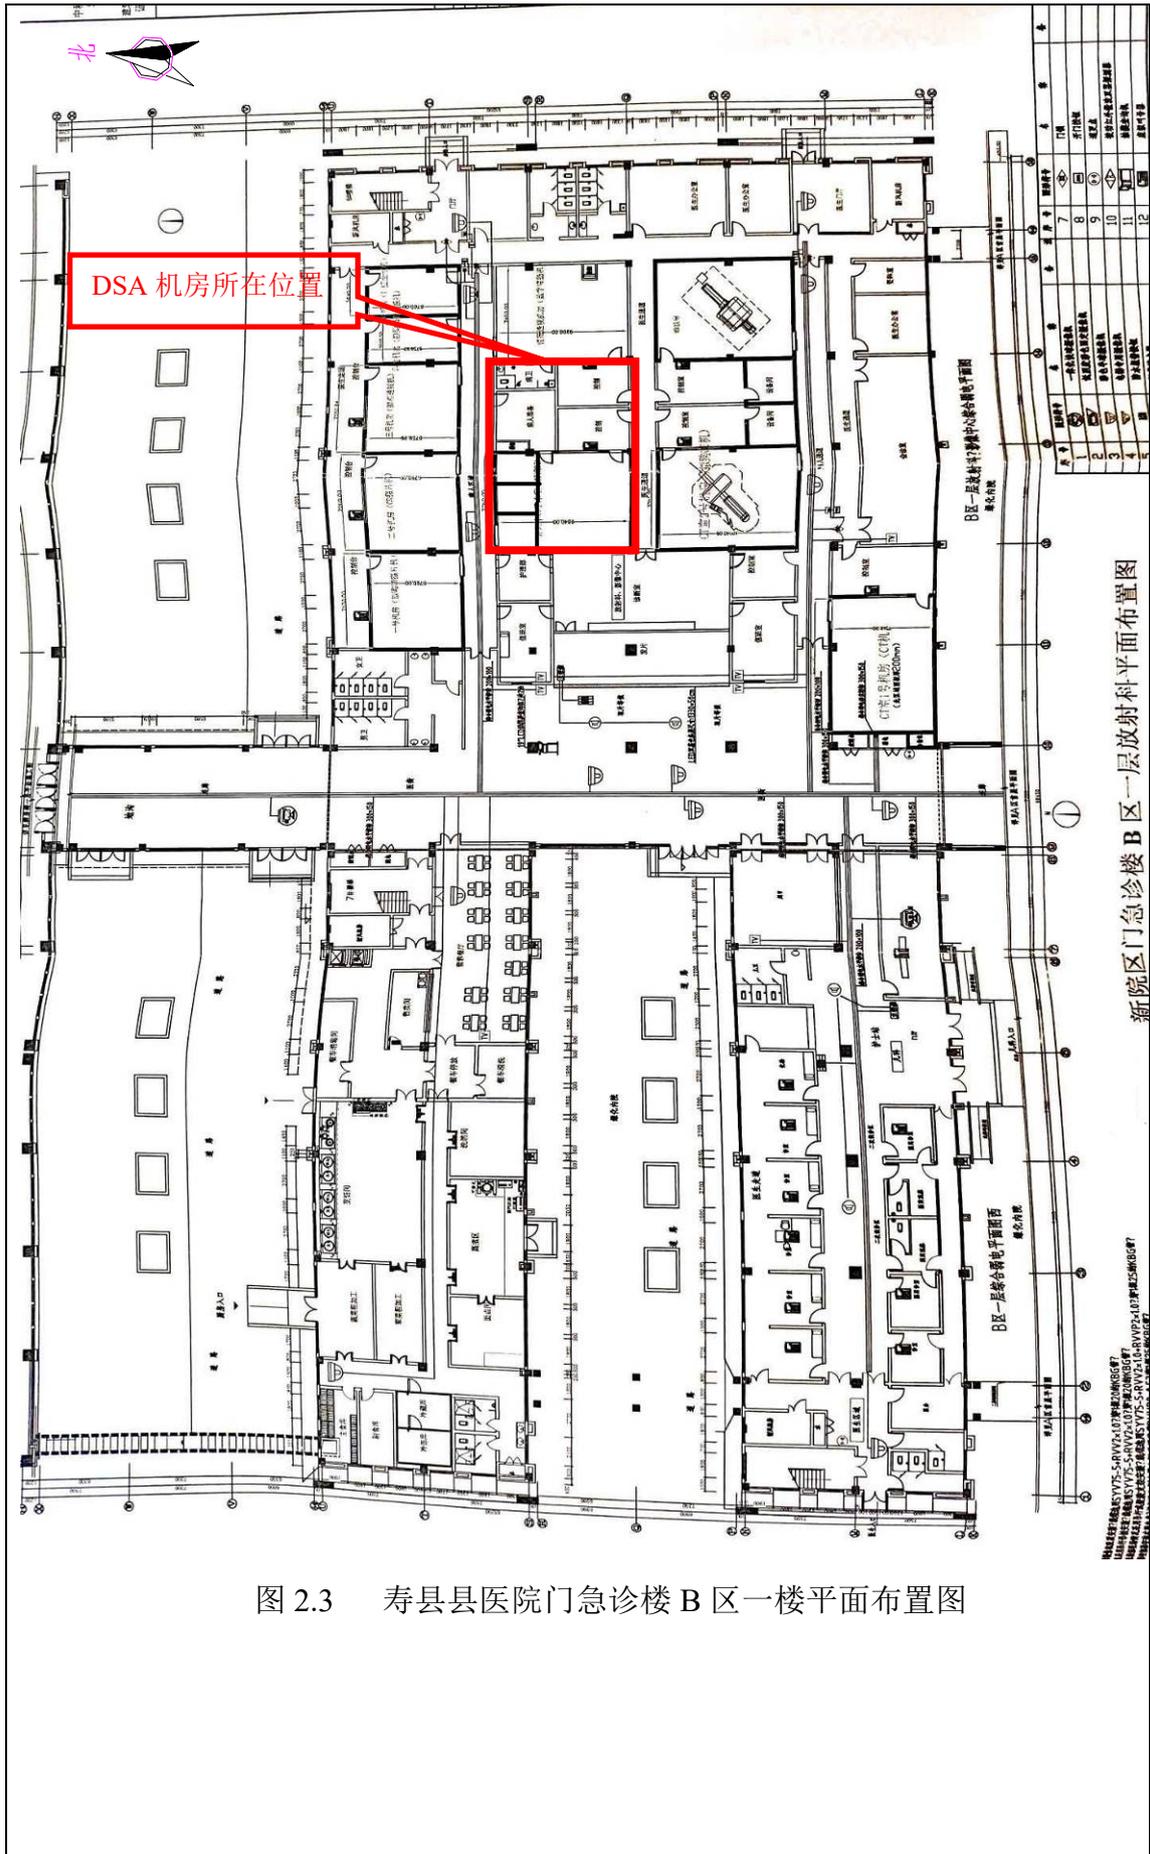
寿县县医院门急诊楼 B 区一楼平面布置图
